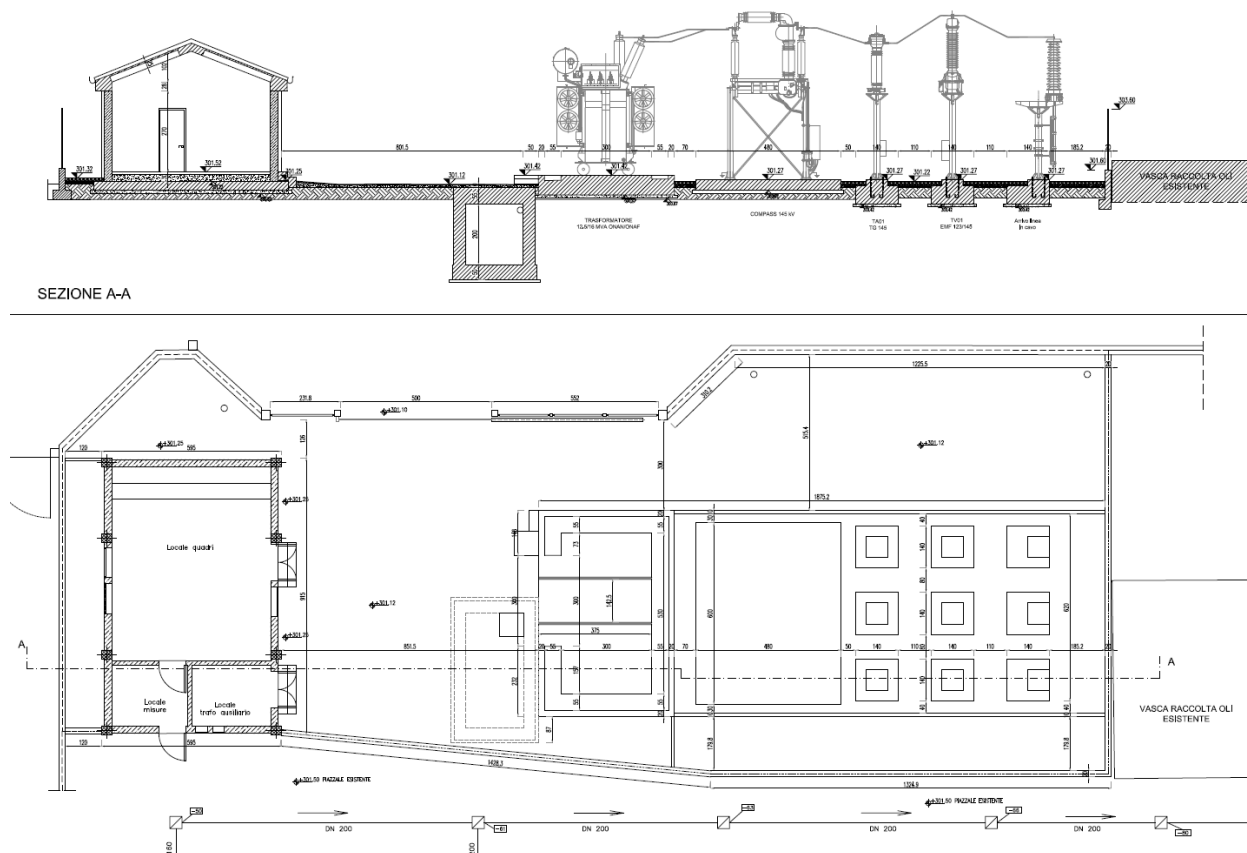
Sezione e planimetria della sottostazione esistente presso S. Benedetto del Querceto
